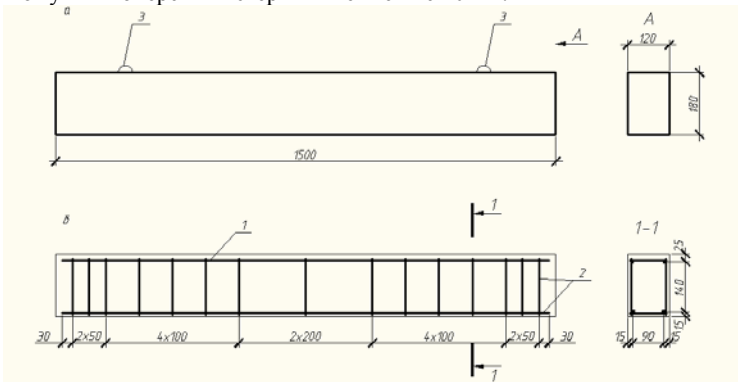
Конструкція та схема армування дослідних зразків балок: а – опалубочне креслення; б – схема армування; 1 – каркас просторовий КП1; 2 – каркас плоский КР1; 3 – монтажна петля.
